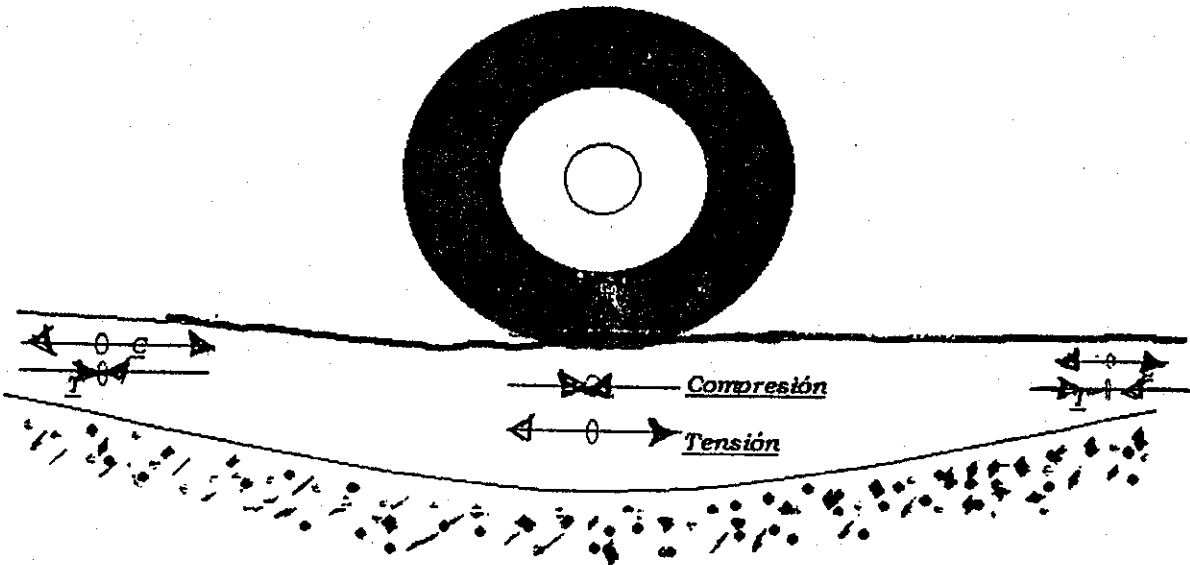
Resultado de deflexiones en esfuerzos de tensión y compresión en la estructura del pavimento.
